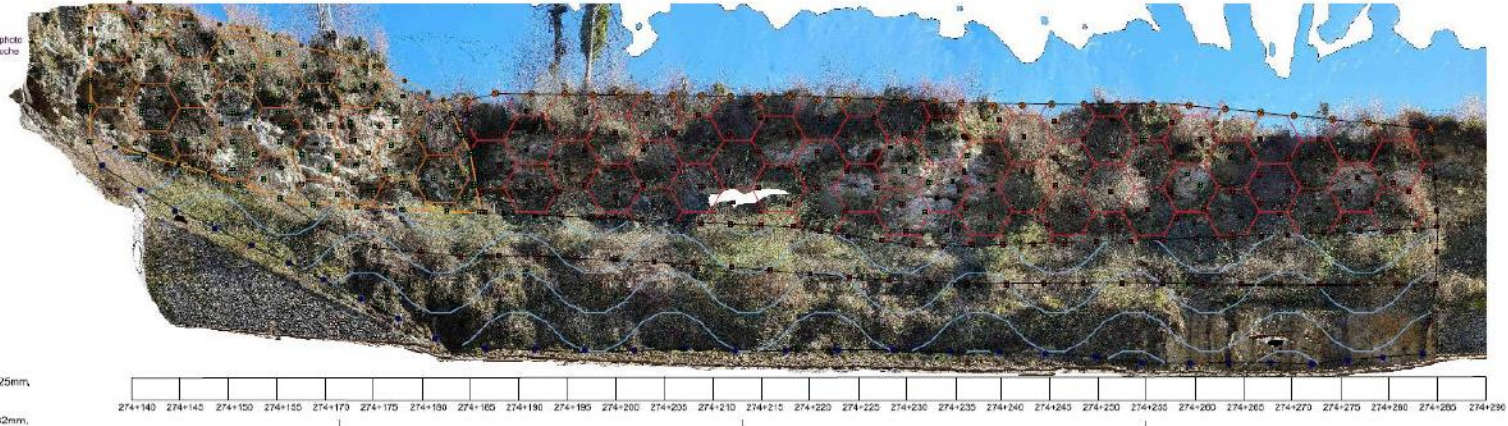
Panorama des travaux de confortement de la tête de tunnel au mur de soutènement du secteur 1
